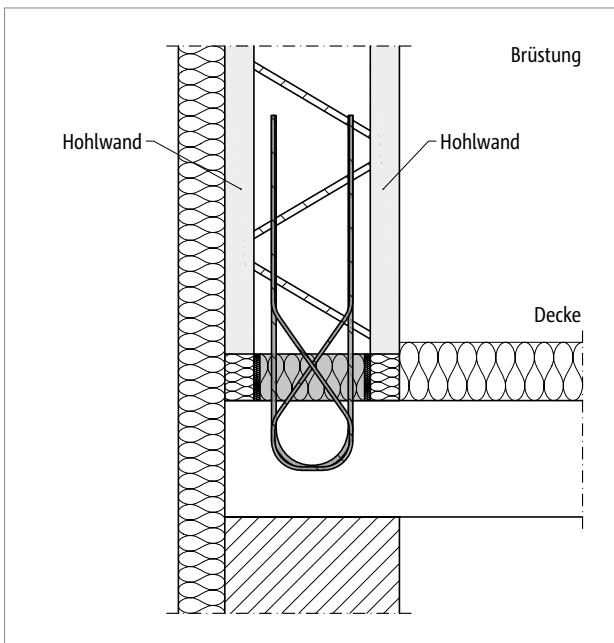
Schöck Isokorb® XT/T Typ AP vertikale Anordnung: Anschluss einer Hohlwand
